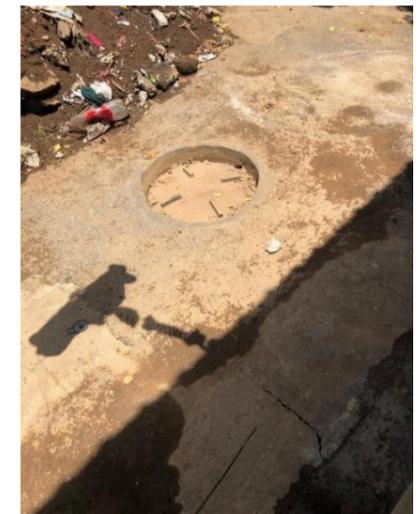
Instalación de nueva tubería. Fuente: oficina de proyecto, INC.
